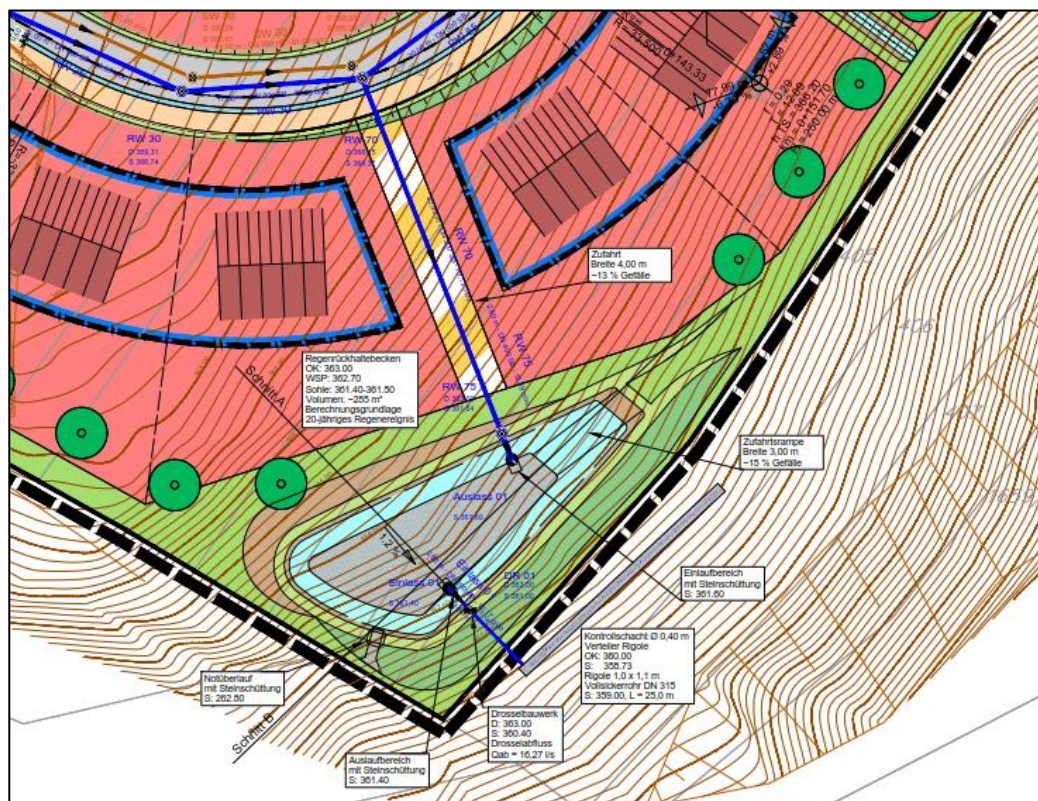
Lageplan-Ausschnitt aus der Fachplanung vom 28.02.2023
